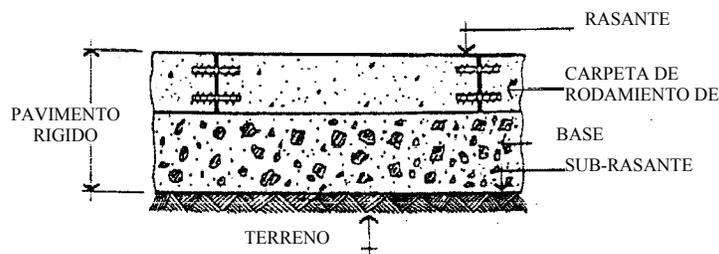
Esquema básico de la estructura de un pavimento rígido
